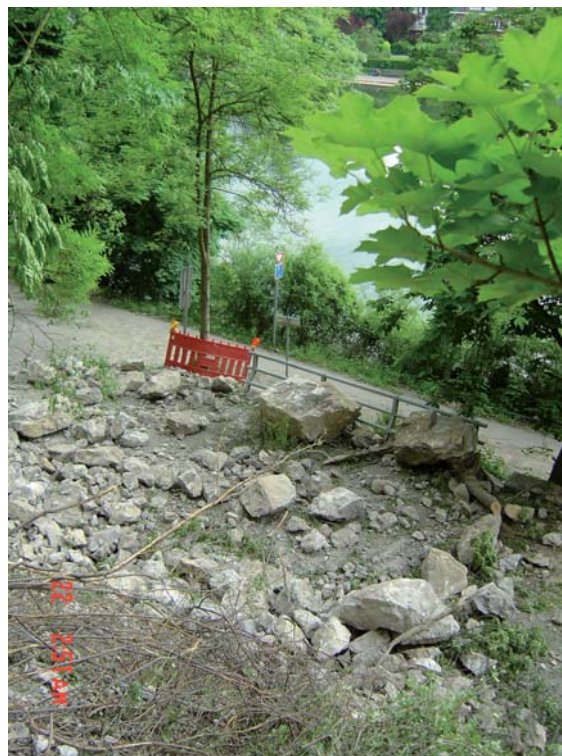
Eboulement massif sur la route Nationale 90 entre Jambes et Profondeville.
